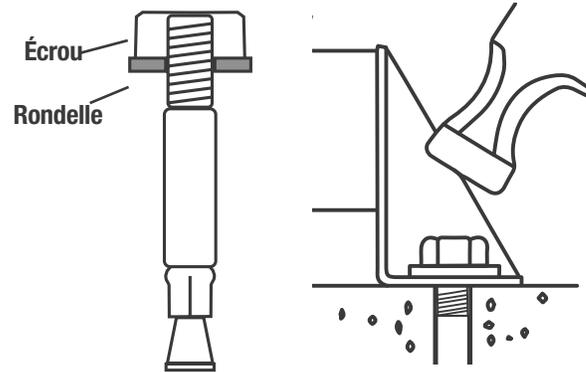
Installation du goujon d'ancrage de la fixation au sol
